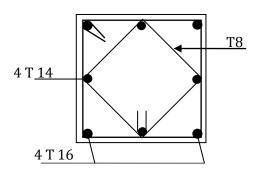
Schéma de ferraillage des poteaux 12^{éme} étage
